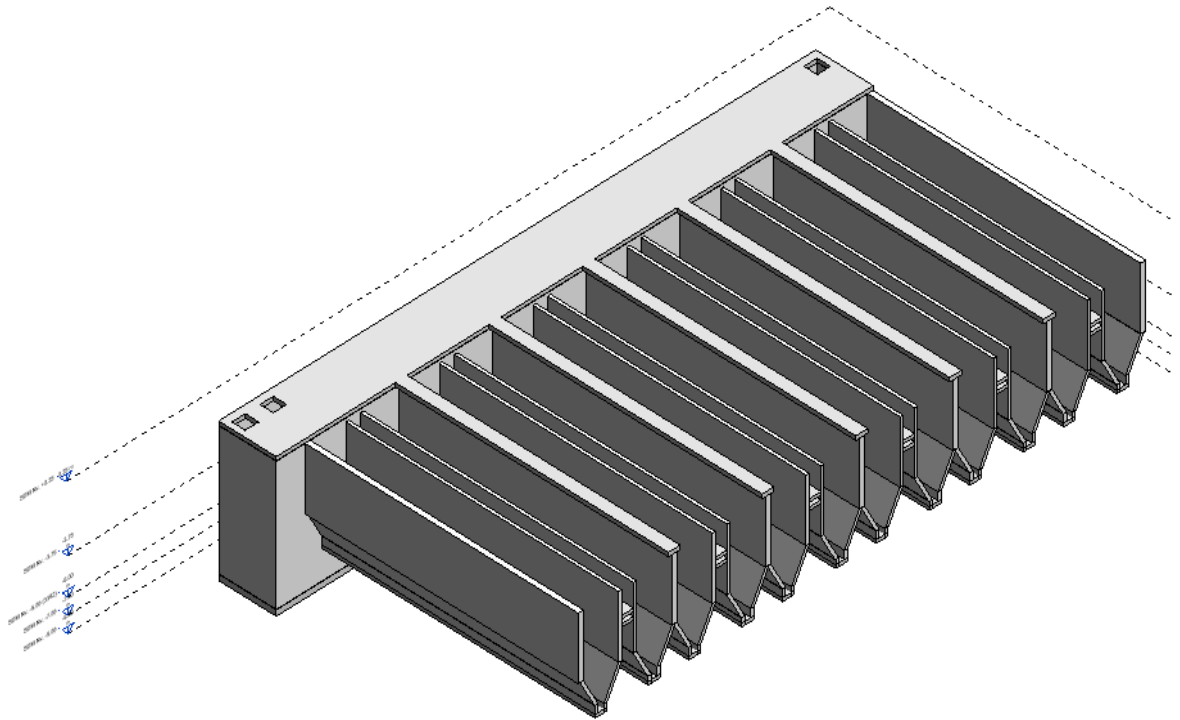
Isometría modelación estructural detalle unión losa de cimentación y muros verticales
